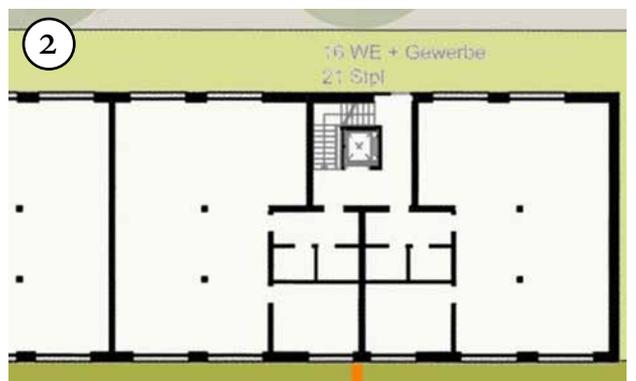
Beispielhafter Grundriss EG
